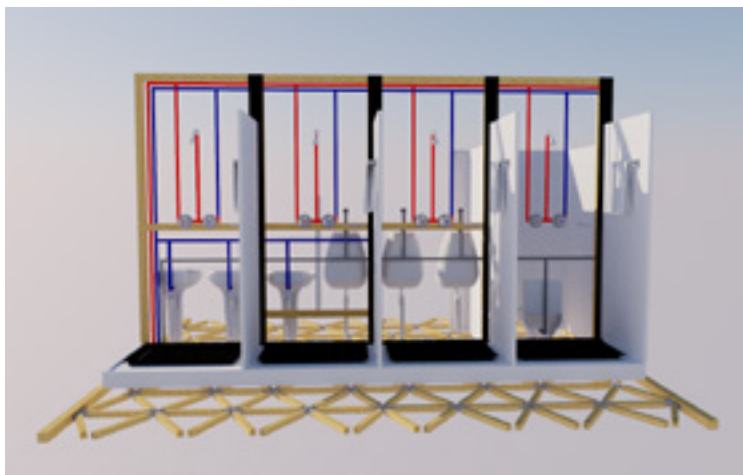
Paredes hidráulicas conectadas - vista dos chuveiros
